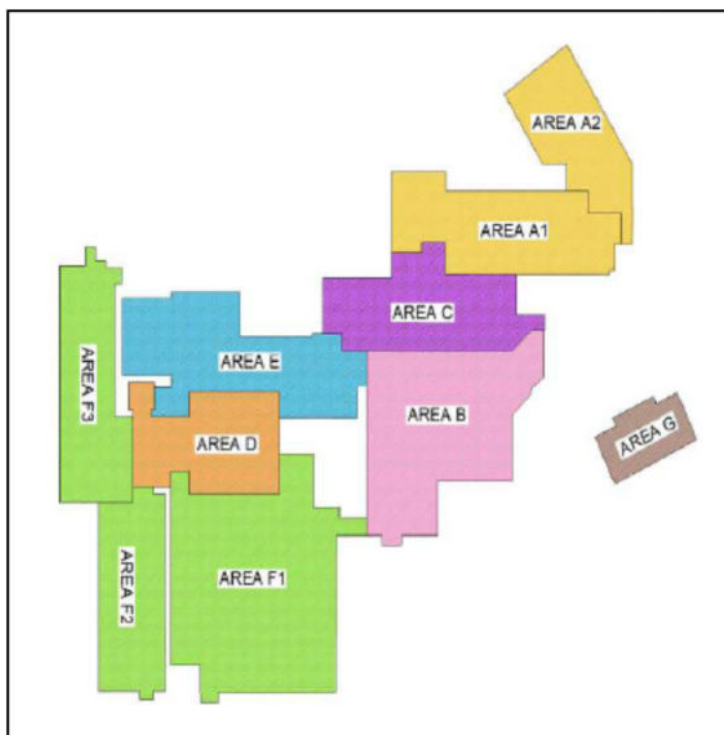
| Planimetria generale dello stato attuale del Plesso Ospedaliero
